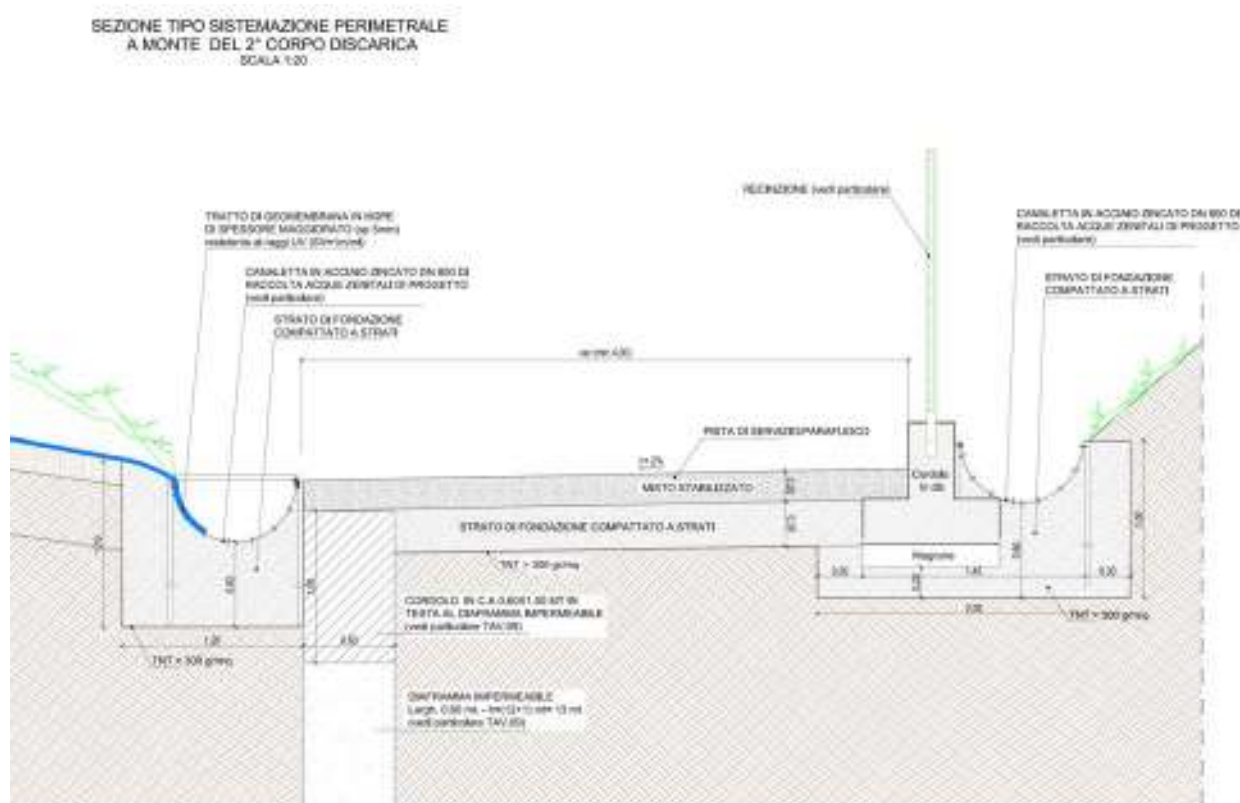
Sezione tipo del diaframma impermeabile e della pista parafuoco e servizio lato monte
